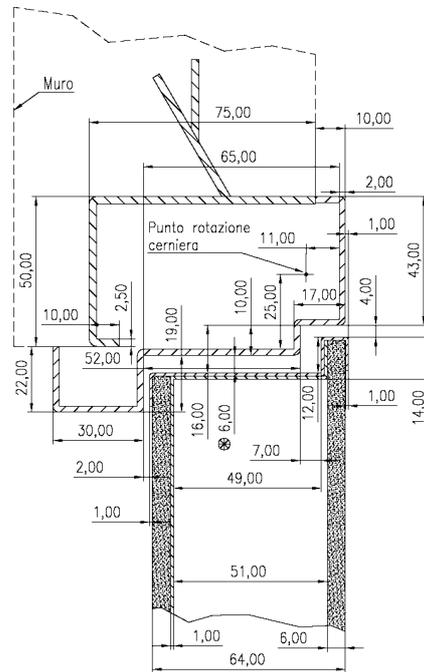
Sezione dall'alto dei profili da impiegare – Upper sight proper profiles
